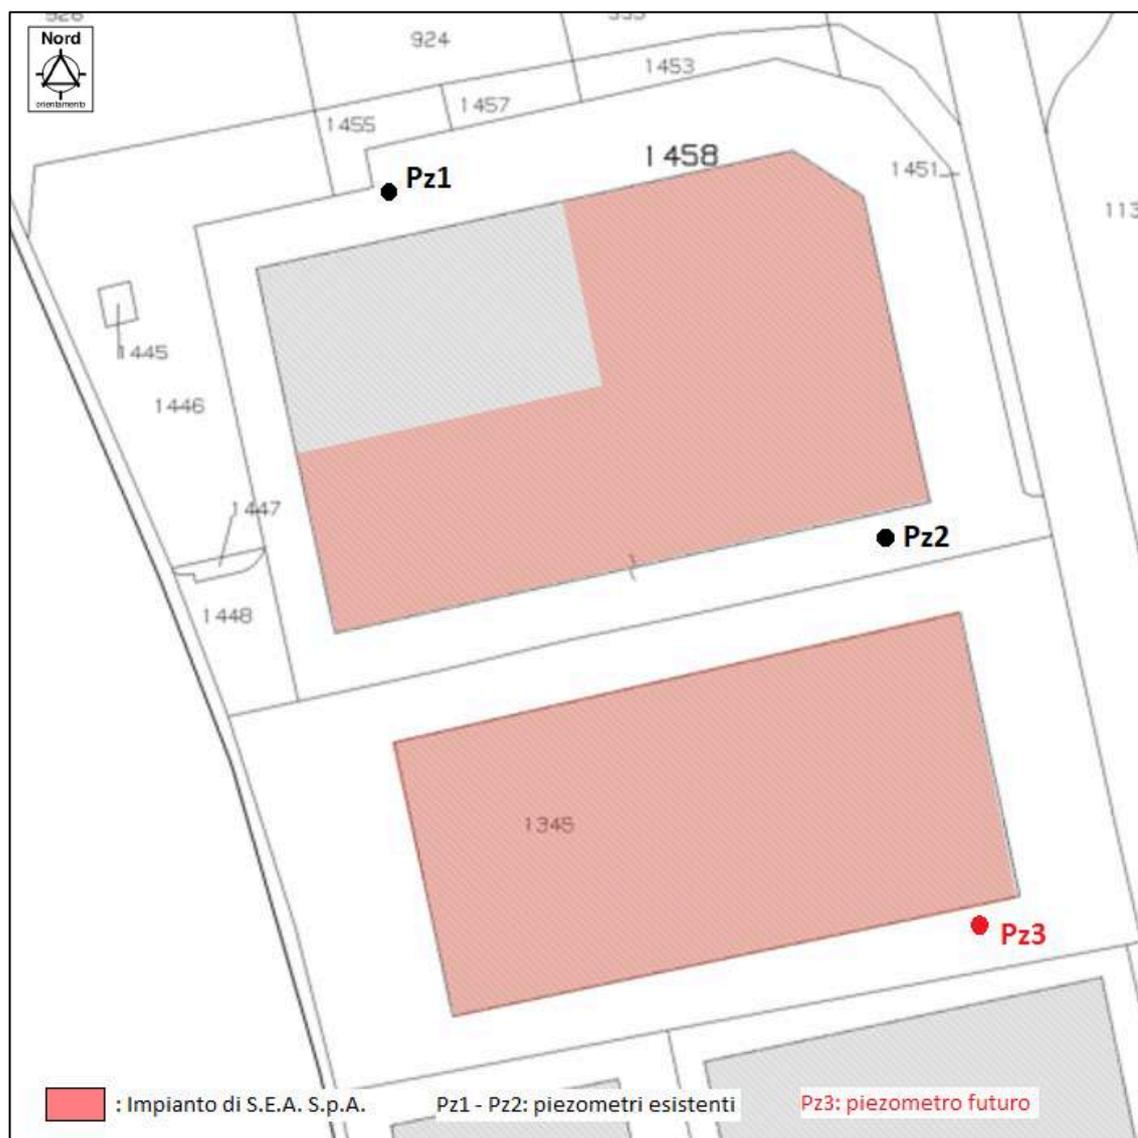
Planimetria ubicazione piezometri di monitoraggio della falda.
